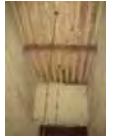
Vista del corte de la cubierta del corredor el apoyado en la columna de cantería
